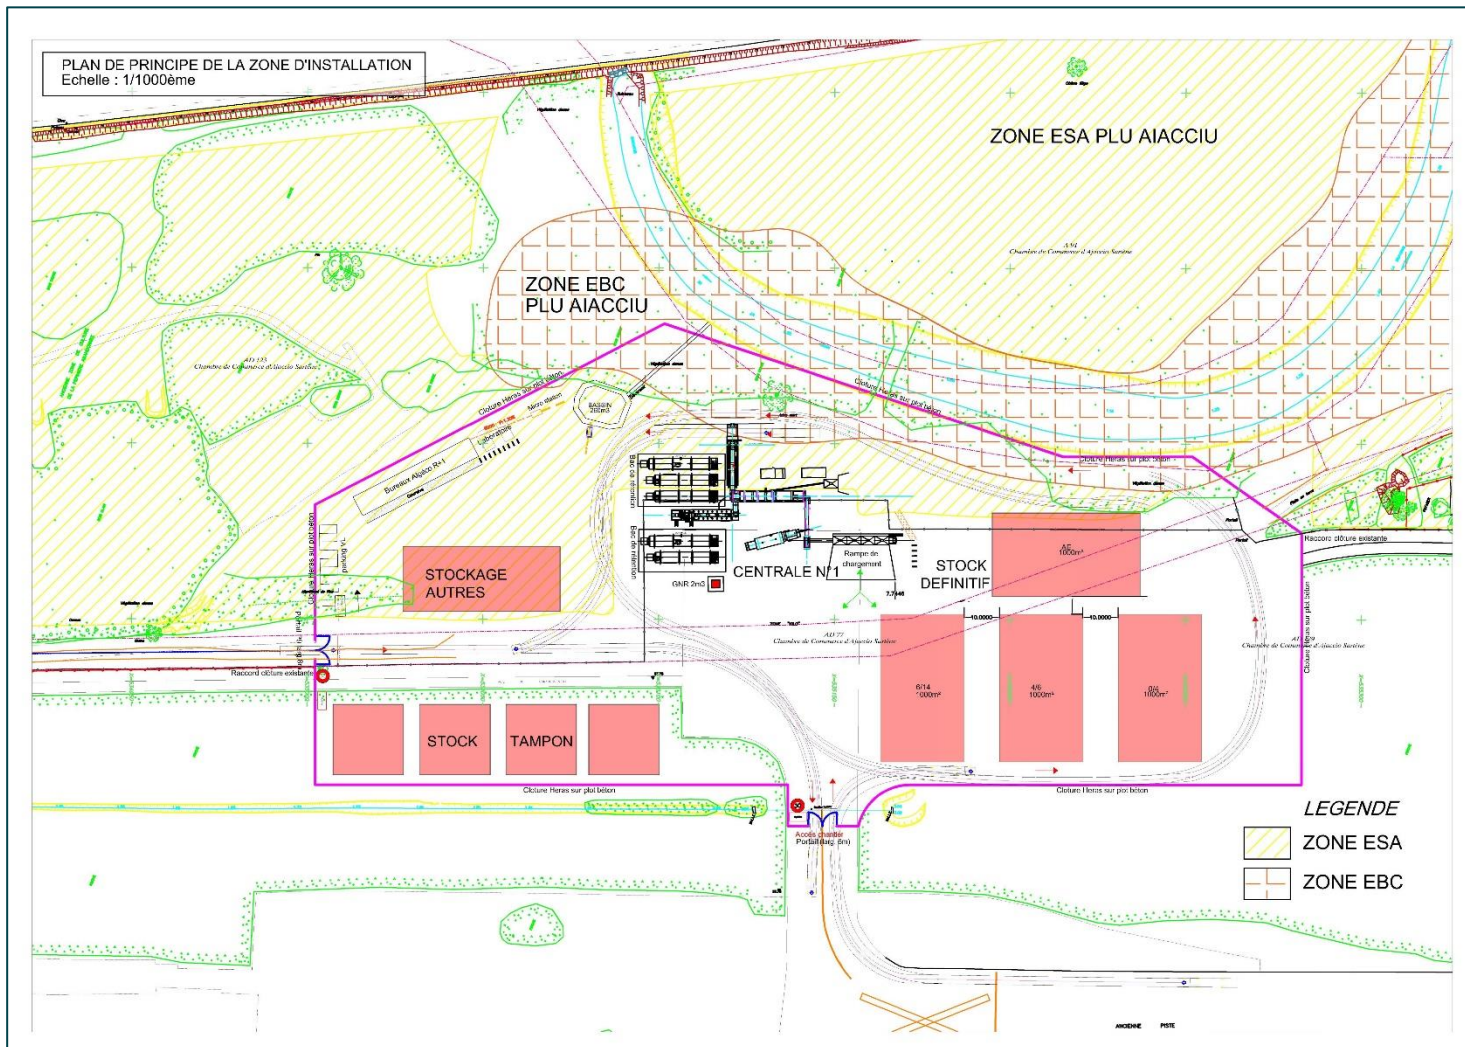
Plan de principe de la zone d'installation lors de la première étape des travaux (renforcement de la piste), Source : Collectivité de Corse
